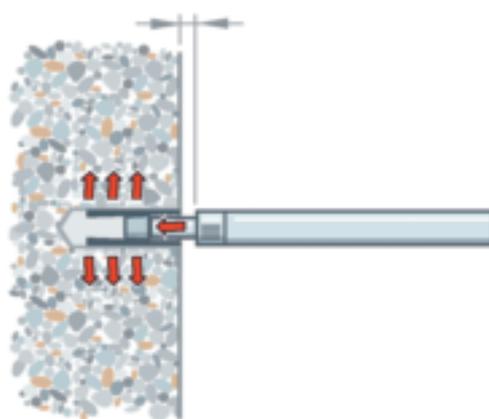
fonctionnement d'une cheville à expansion par déformation contrôlée (adhérence par friction entre l'extérieur de la douille et la paroi du trou de fixation).
